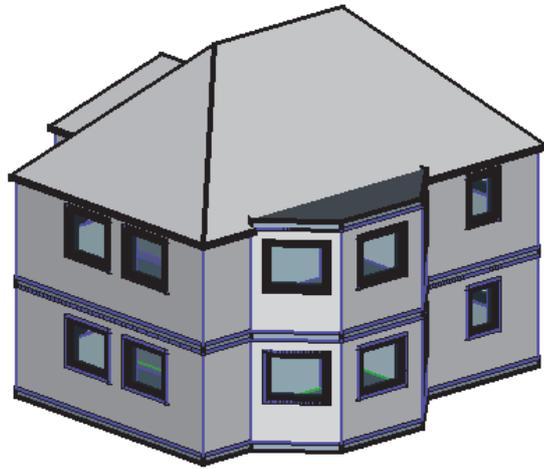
Hauskonstruktion mit zwei Stockwerken und Dach
